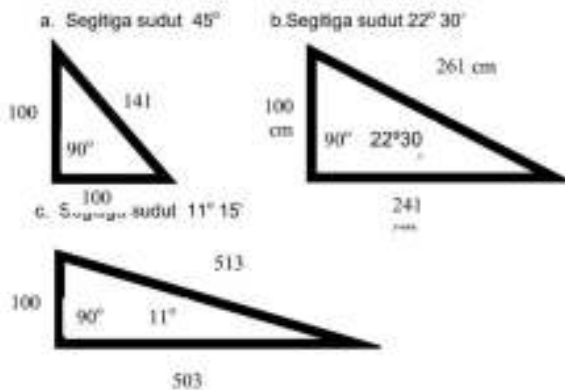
Membuat Sudut 90 Derajat di Lapangan
